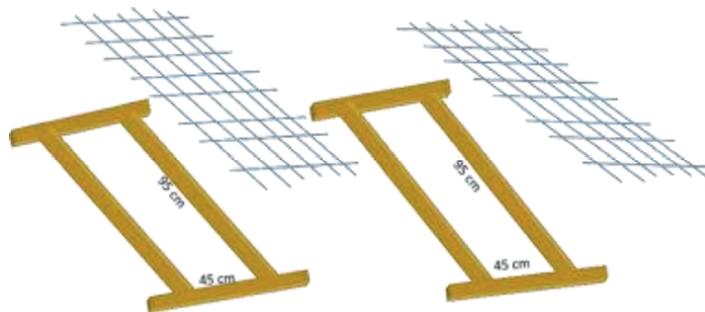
Armado de la cimbra para la construcción de tapas de las cámaras del baño
